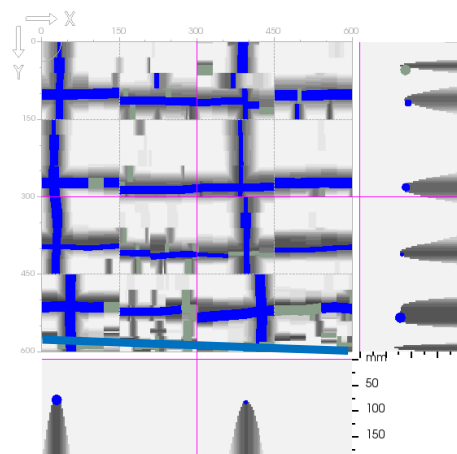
Poutre Pt01 – Travée 4 à mi-travée
